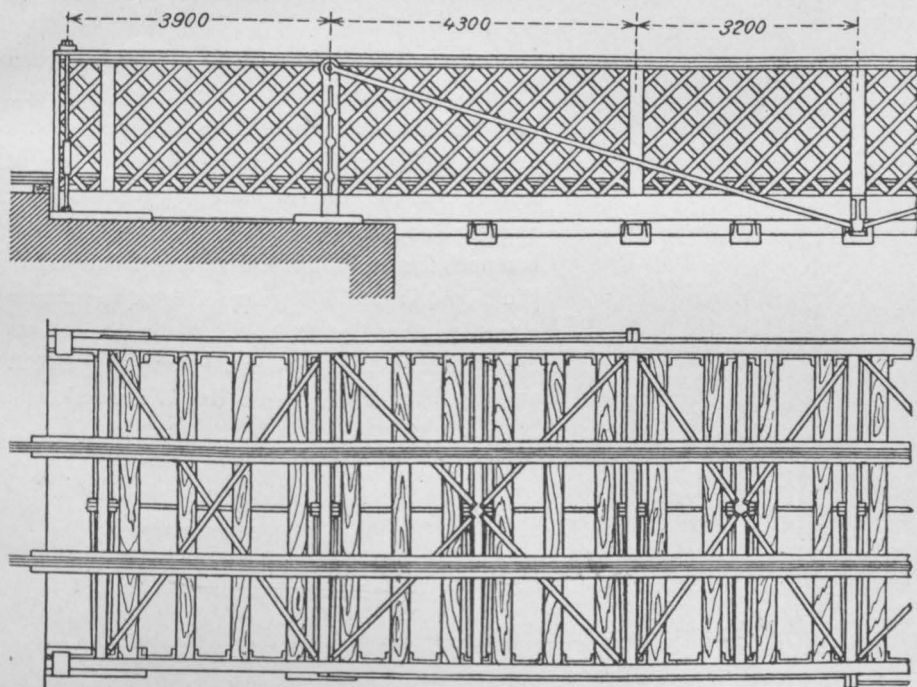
Ansicht und Grundriß der Gitterbrücke über die Wupper beim Bahnhof Rittershausen. 1847.
